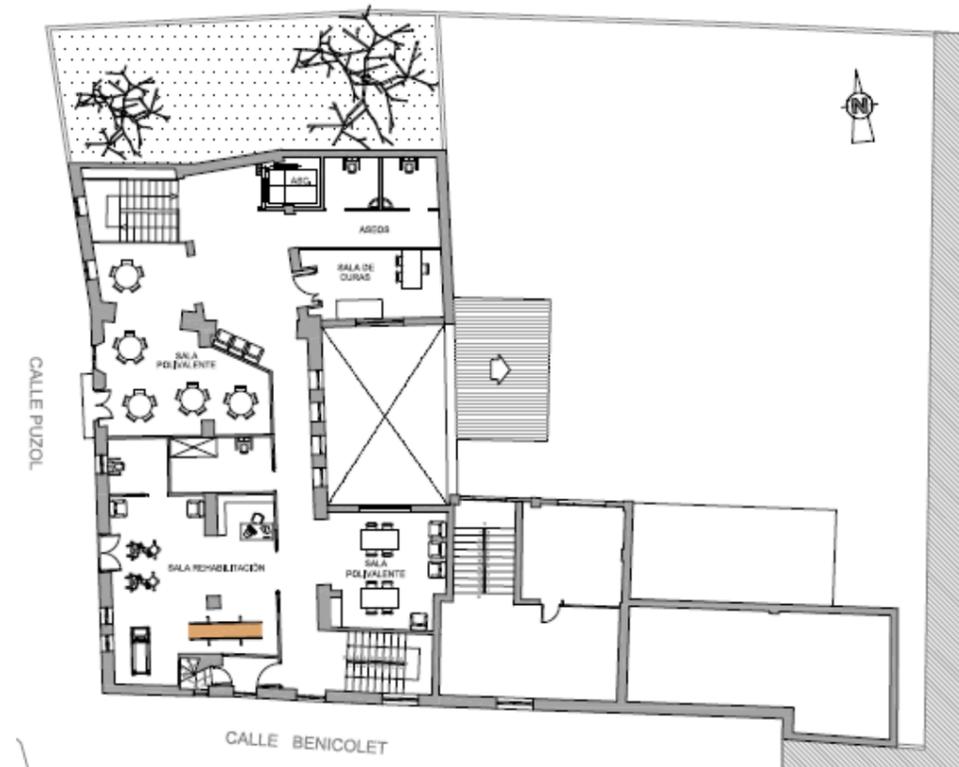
Distribución Planta Primera Centro de Día (Propia)
